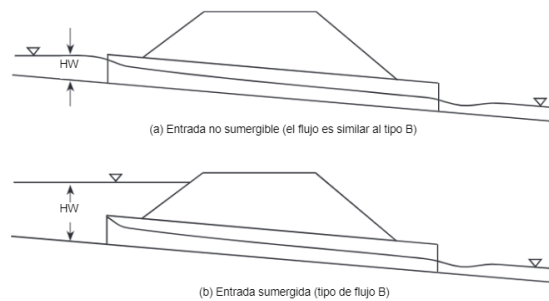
Ejemplo de alcantarillas bajo control de entrada
